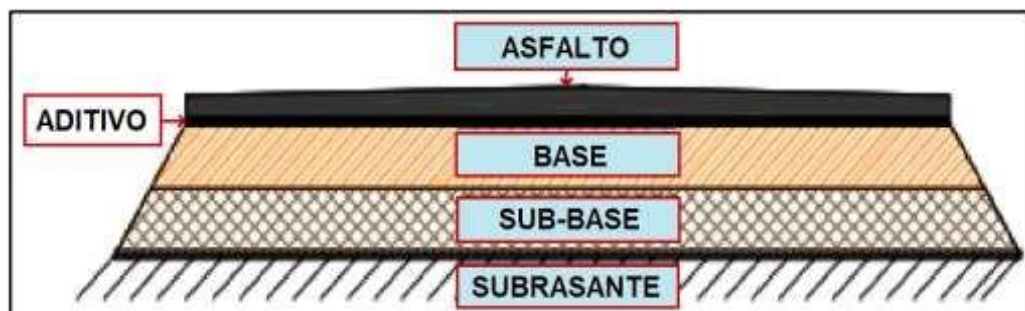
Sección Transversal del Pavimento Semi Rígido
